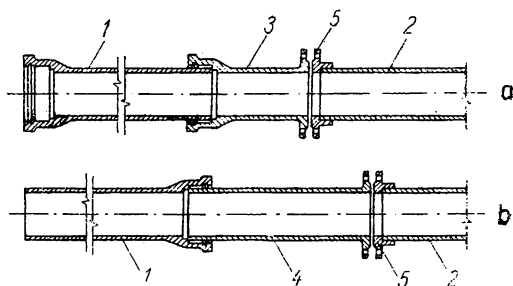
Trecerea de la tuburi de fontă de presiune cu mufă la țevi de oțel și invers, folosind piese de trecere de fontă și flanșe :
